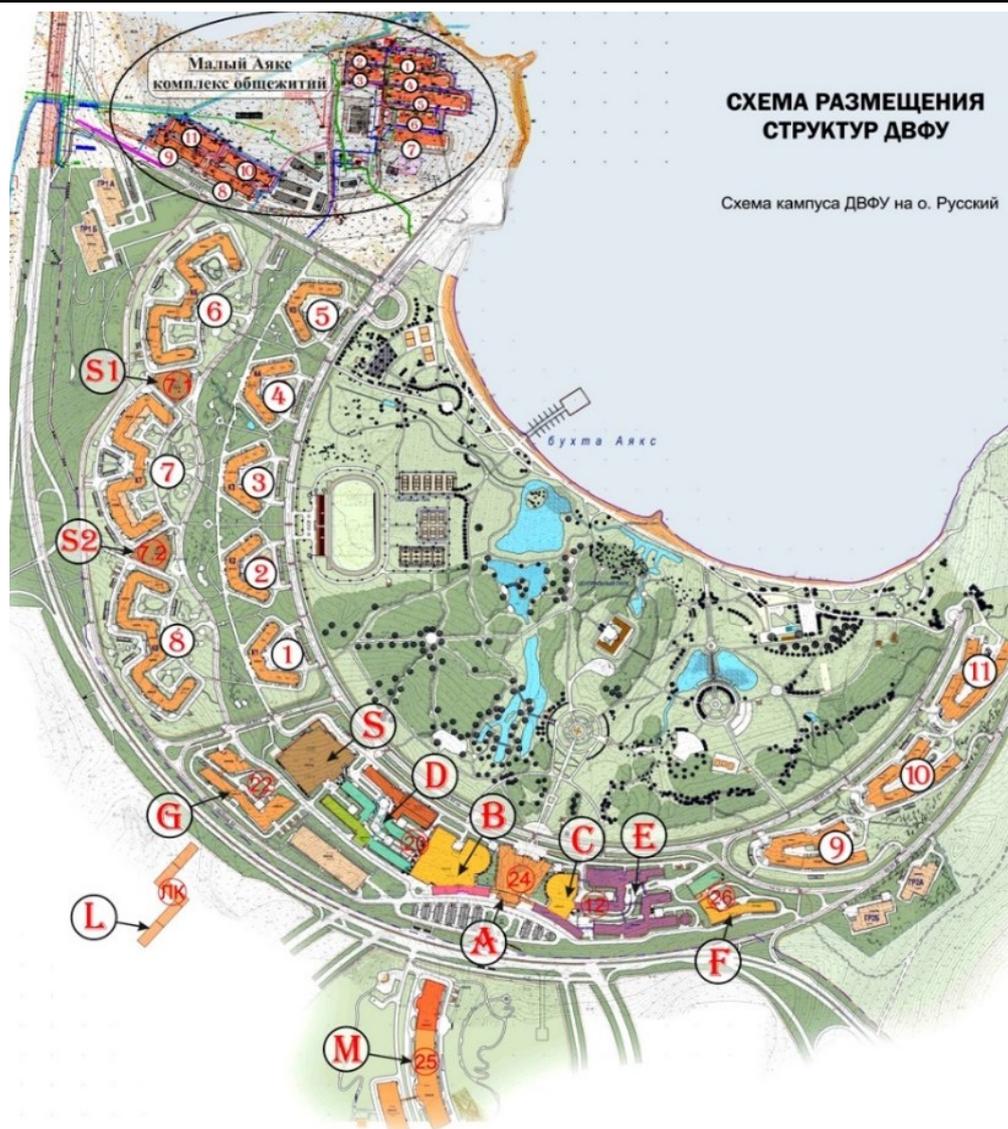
Генеральный план ДВФУ, 2008–2009 гг.
